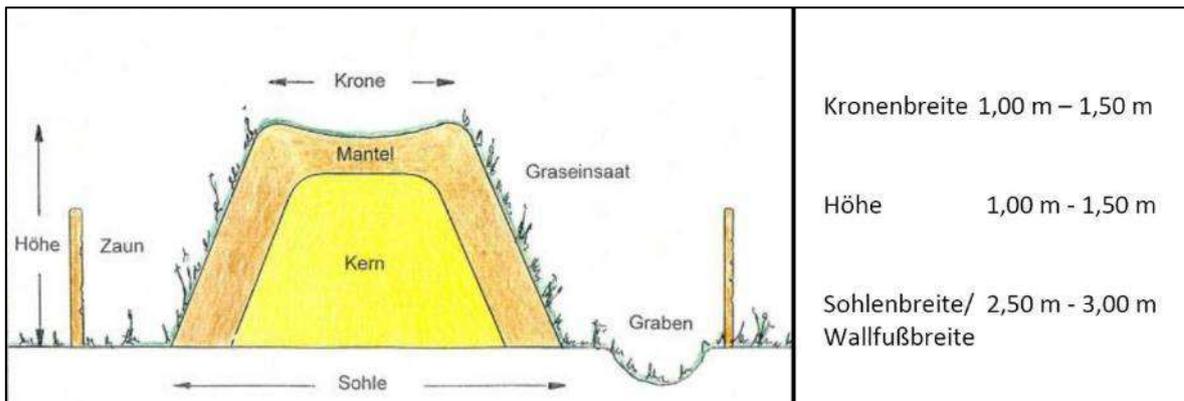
Aufbau des Wallkörpers und Pflanzschema
